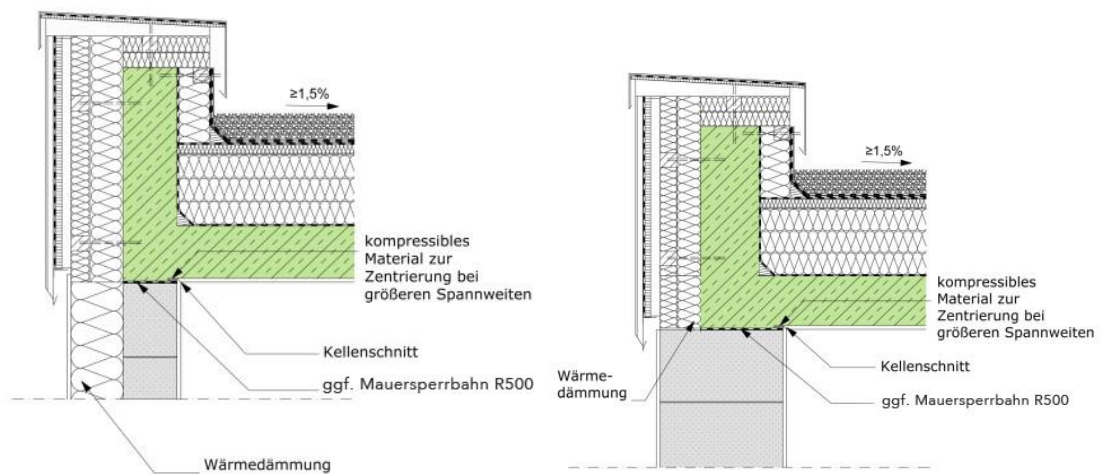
Beispielhafter Aufbau eines Wand-Dachdecken-Knotens:
